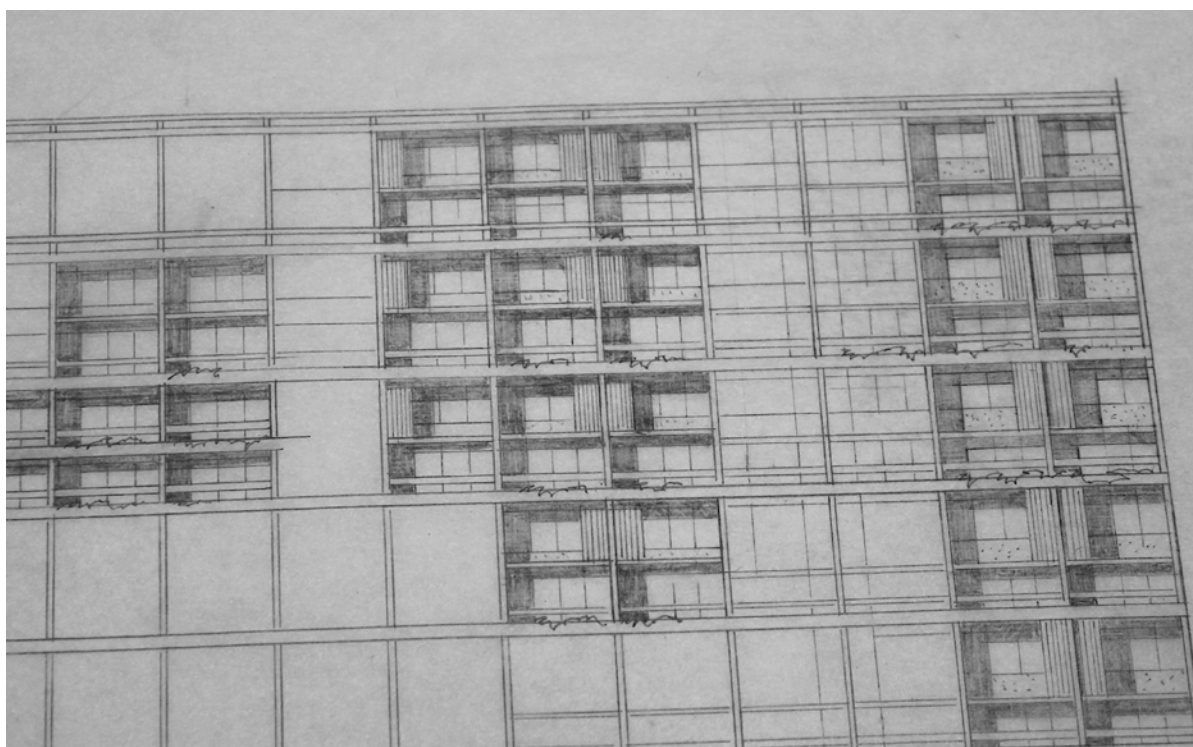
Plansje fra Tunnelbanekontorets arkiv. Illustrerer hvilke hensyn de var opptatt av.
